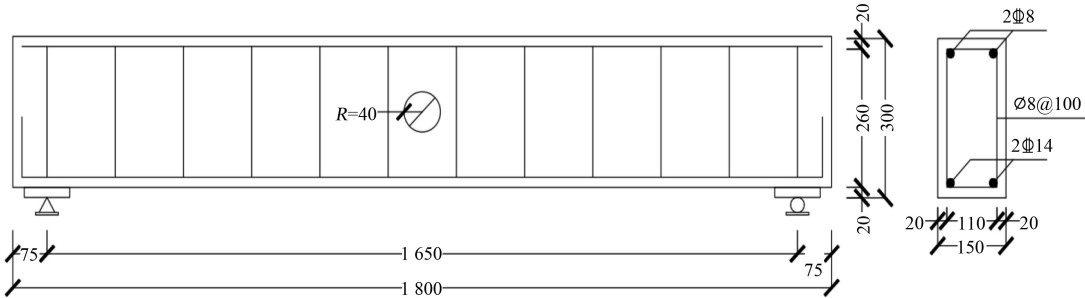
腹部开孔的钢筋混凝土梁 C-80-1-Mid 示意
